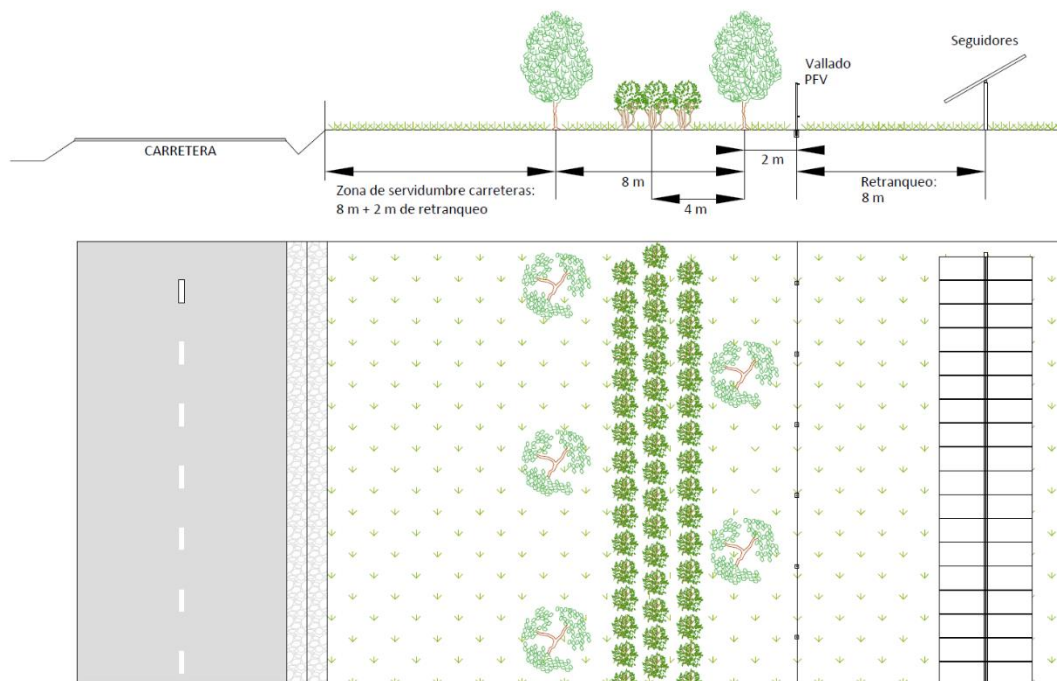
Planta y sección tipo de las pantallas de ocultación
